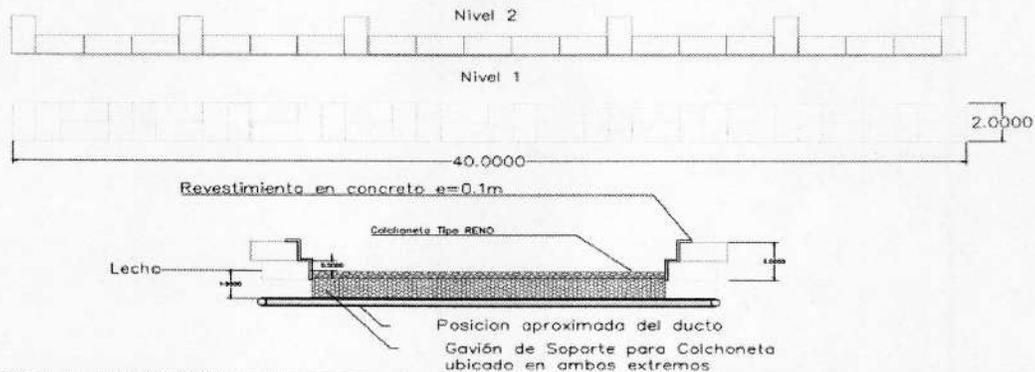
Esquema en planta y detalle de las obras ejecutadas en el Caño La Llana, en el cruce subfluvial del Sistema de Transporte de Hidrocarburos Ayacucho – Galán 14” (PK 99+950). Fuente: CENIT, 2022.
